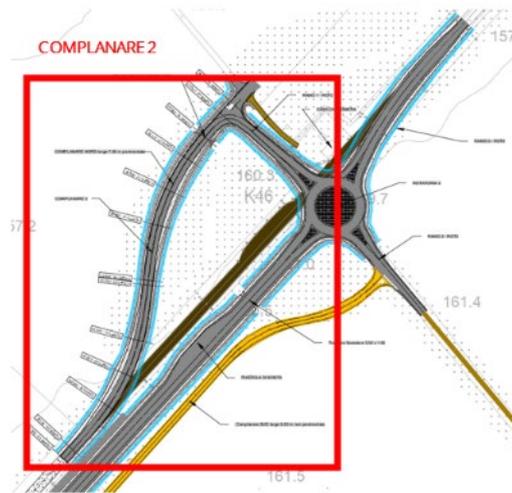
COMPLANARE 2: PLANIMETRIA DI PROGETTO
